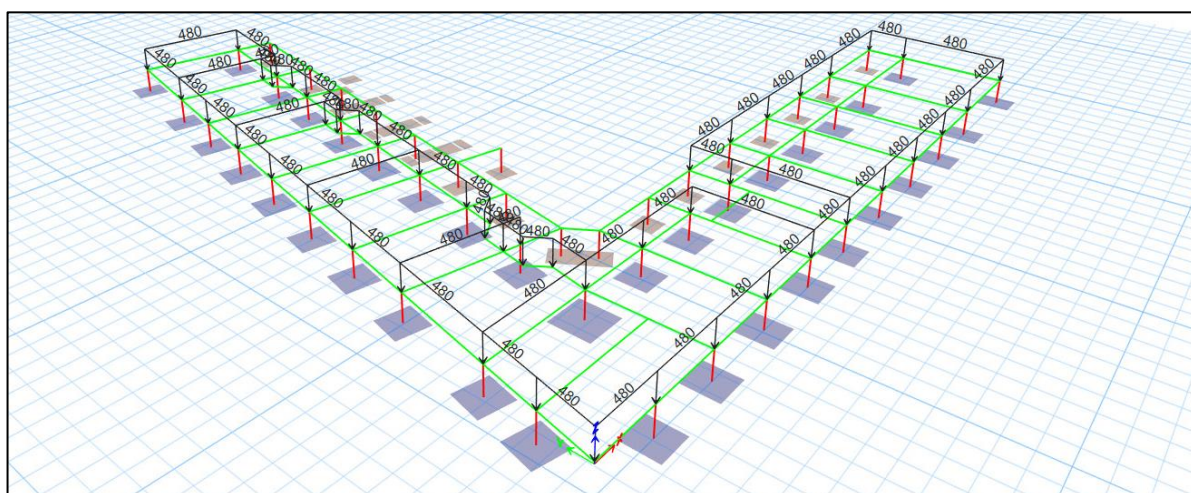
Carga muerta en vigas (kg/m) Niv. +0.10m
